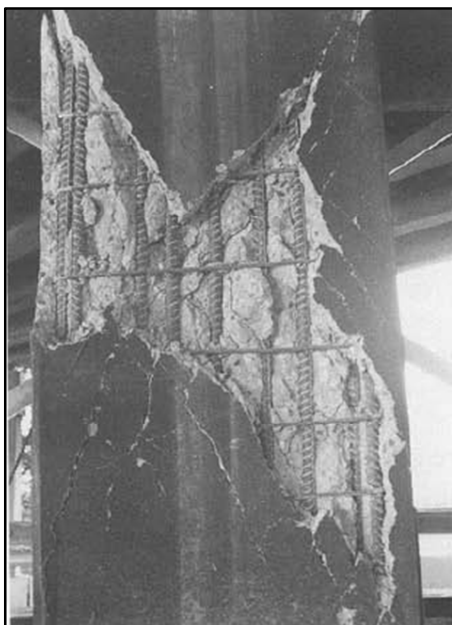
Daño por cortante de las columnas del distribuidor I-5/I-605, sismo de Whittier 1987. (Tomado de Priestley, Seible y Calvi, 1996)
